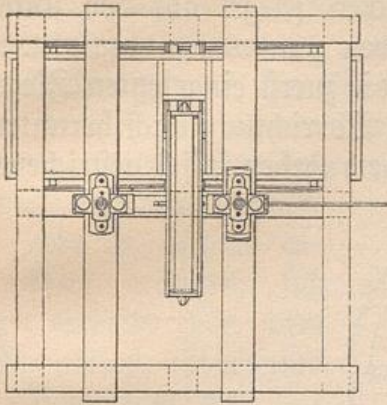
Oberer Grundriß. Senkvorrichtung. Fig. 52. Unterer Grundriß.
